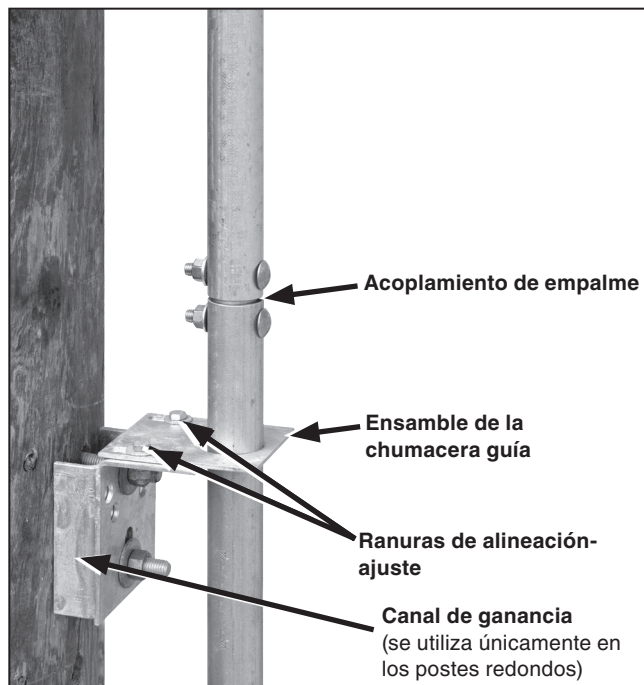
Ensamble de la chumacera guía y acoplamiento universal (posiciones intermedias).
